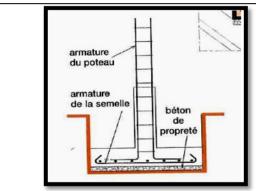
Coupe transversale sur semelle et poteau. Source: Disponible sur: < http://coursexosup.blogspot.com/2015/04/fondations -introduction-toute-structure.html > (Consulté le 20/12/2016).
